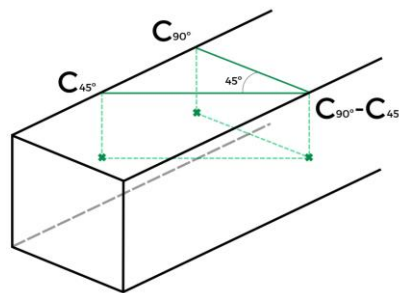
Marcajes de las medidas transversales y a 45° en un punto C de una viga.
